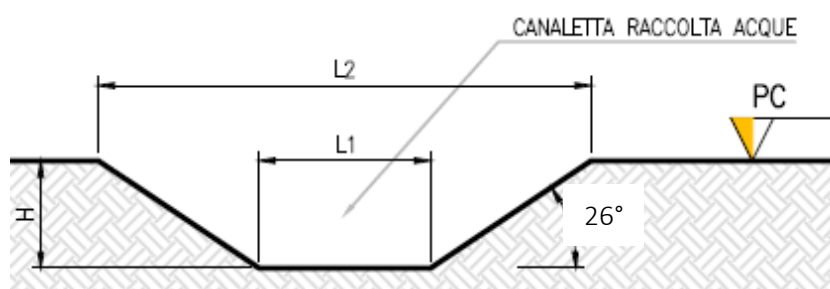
Sezione tipologica canaletta di drenaggio realizzata in scavo
